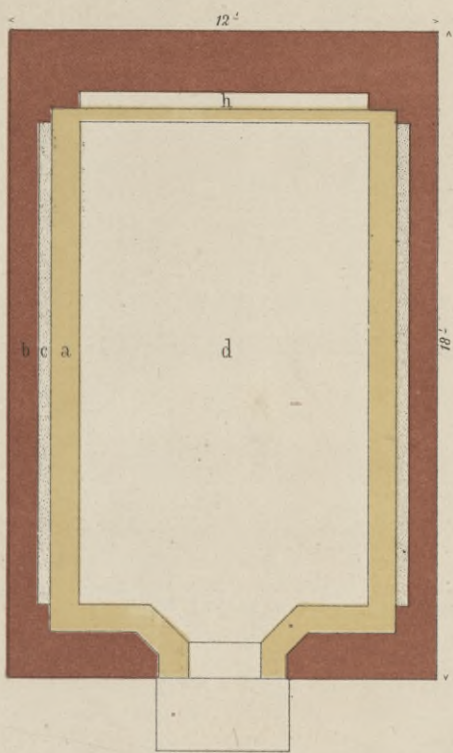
Grundriss über der Decke des Heerdes.
